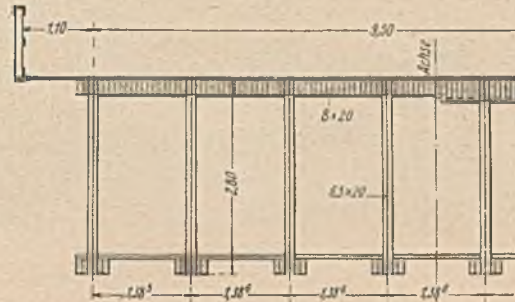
Schnitt durch den Scheitel des Lehrgerüsts.
